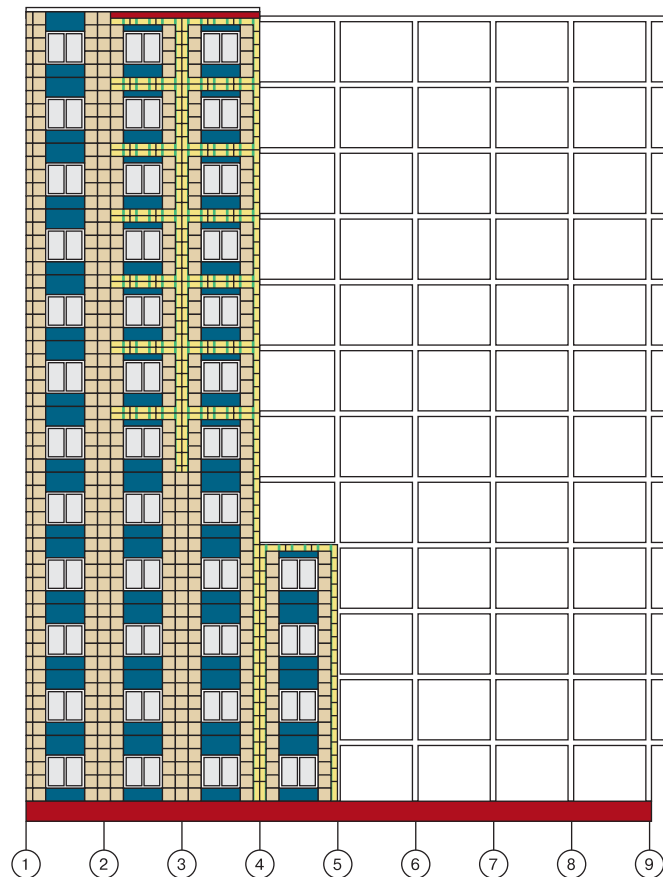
Здание, возводимое из панелей методом укрупнительной сборки по монолитному железобетонному каркасу
